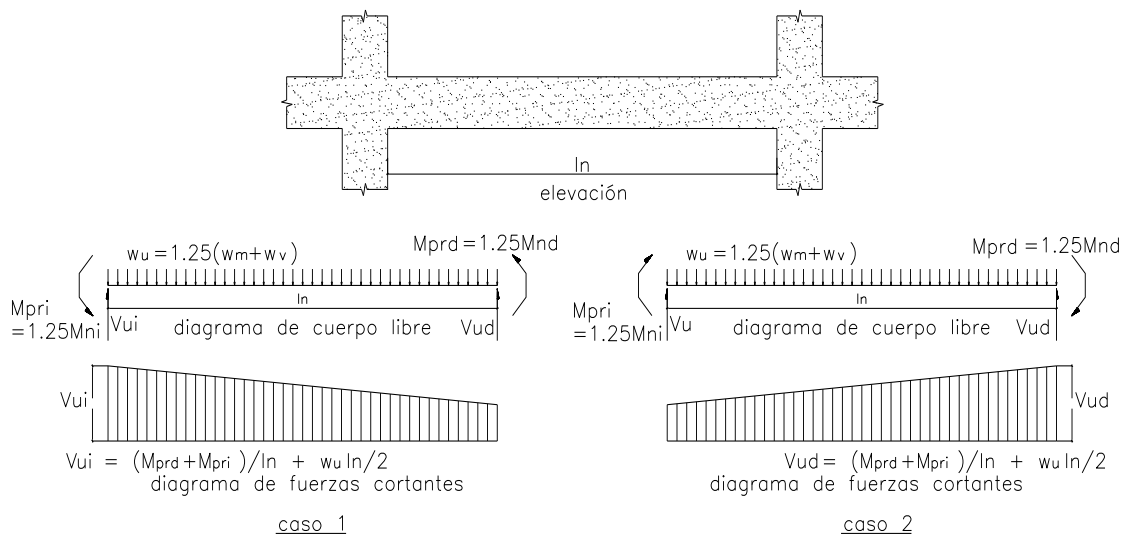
Fuerza cortante de diseño en vigas
